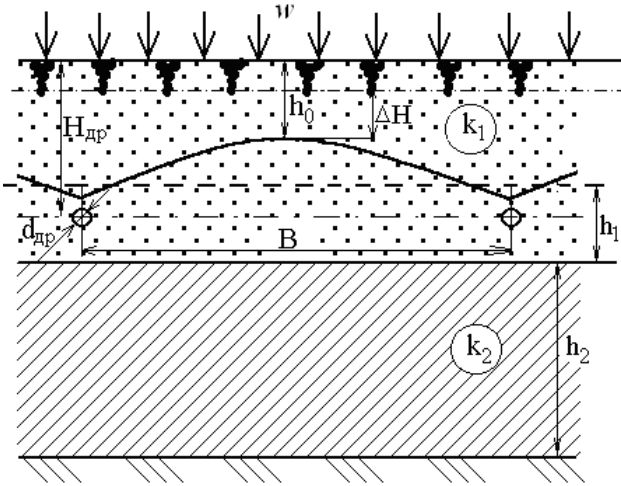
Розрахункова схема двошарової товщі з дренажем у верхньому шарі
